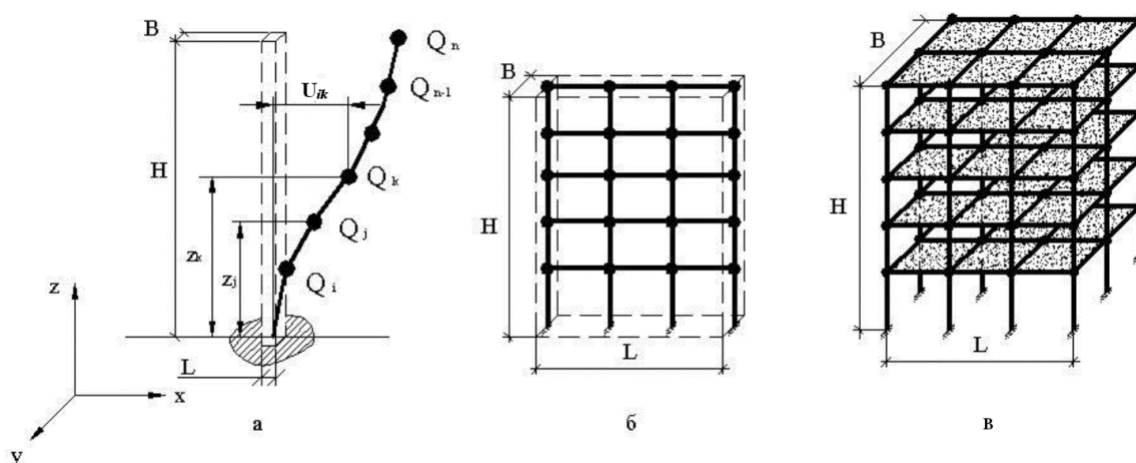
Расчетные схемы зданий и сооружений:
